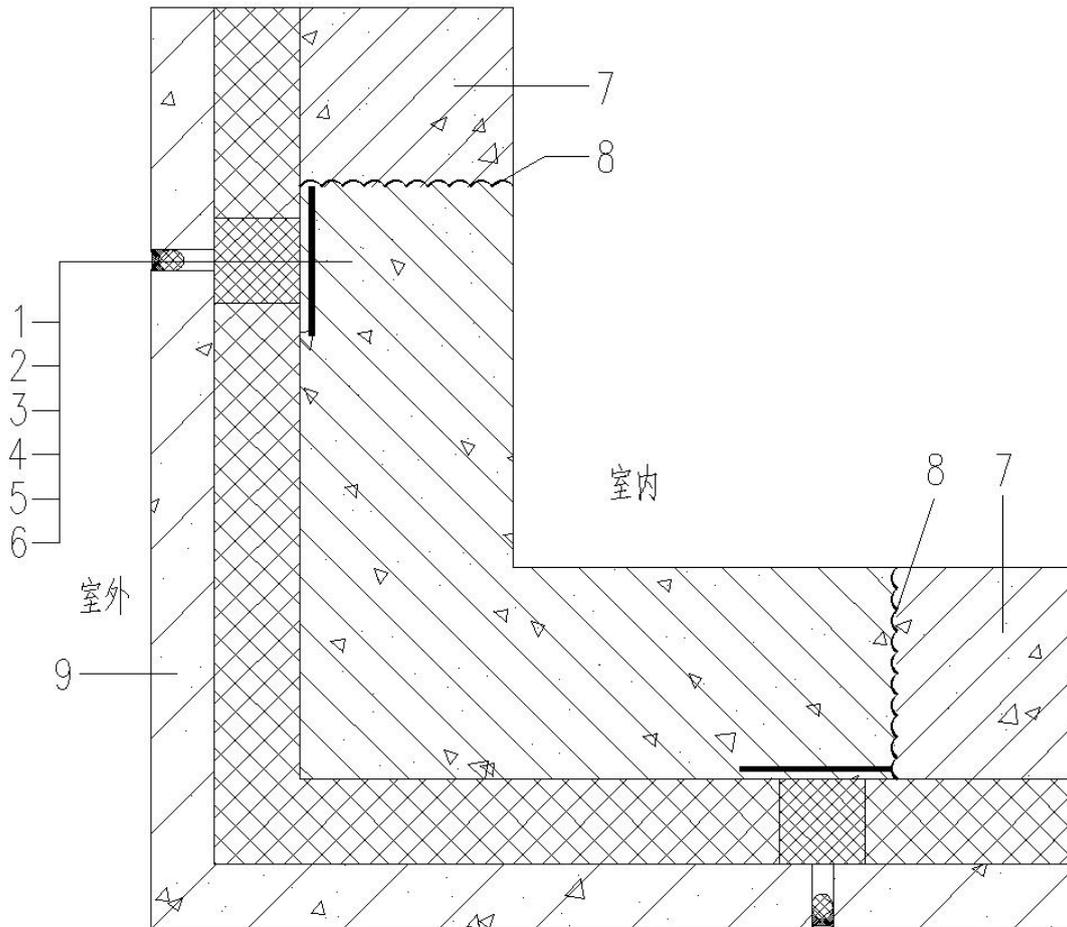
拐角预制混凝土夹心保温墙板垂直缝密封防水构造
